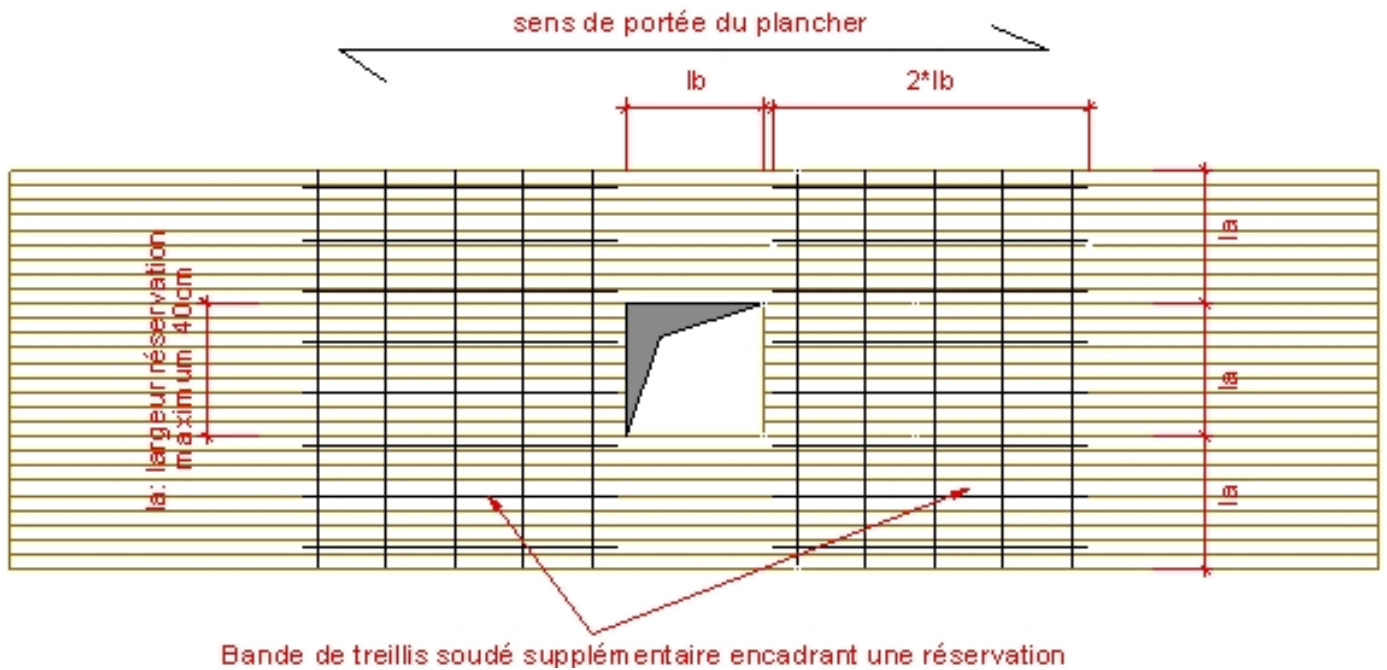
Principe de renforcement du ferrailage autour d'une réservation
